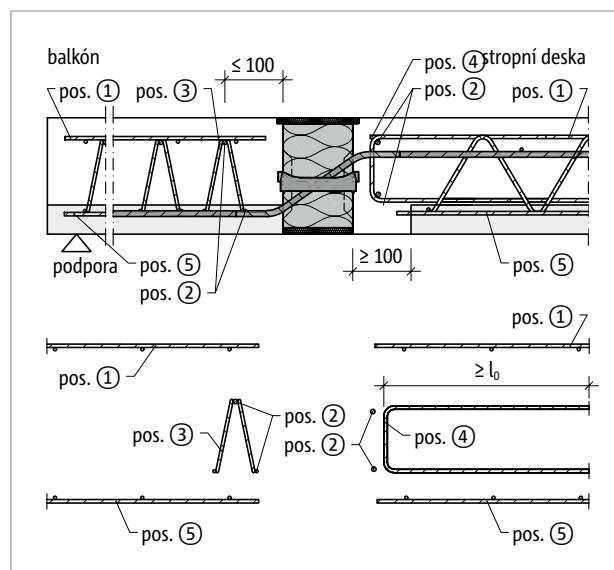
Schöck Isokorb® XT typ QL-VV5 až VV11: Napojovací stavební výztuž
